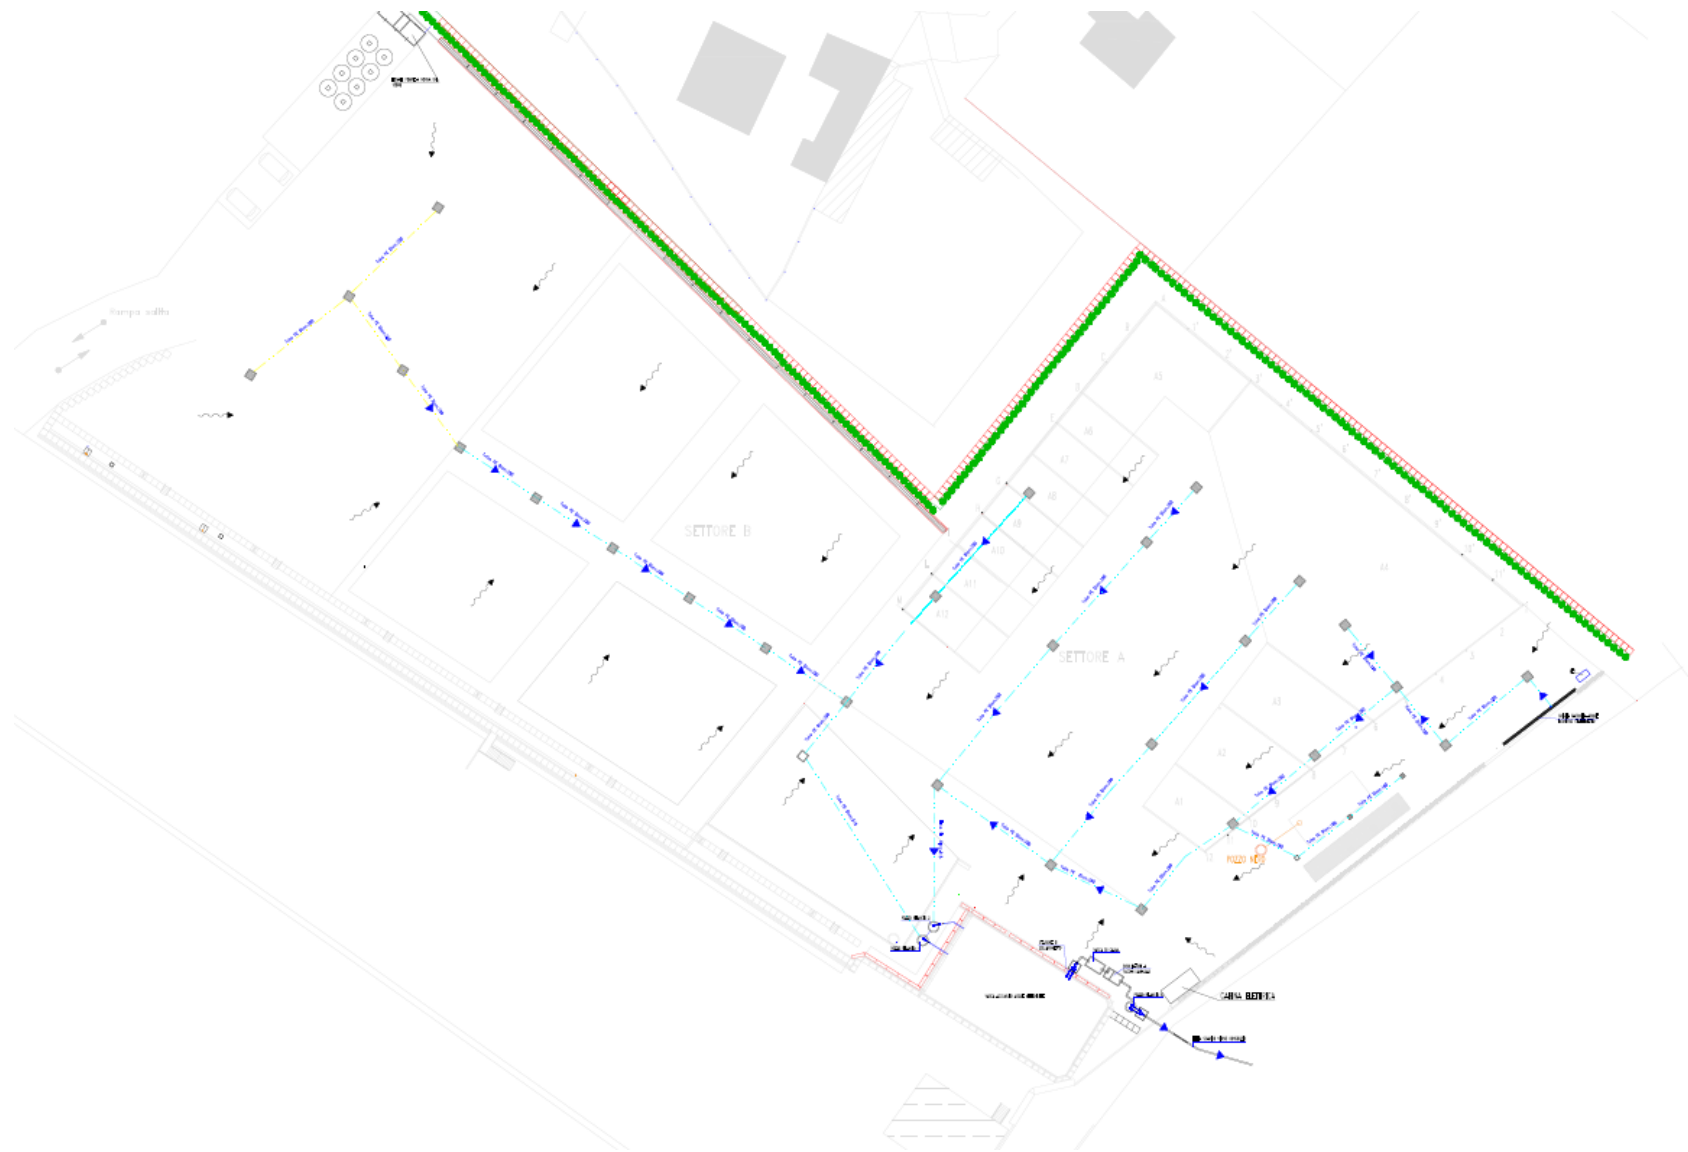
Planimetria della nuova rete di raccolta delle acque di dilavamento
